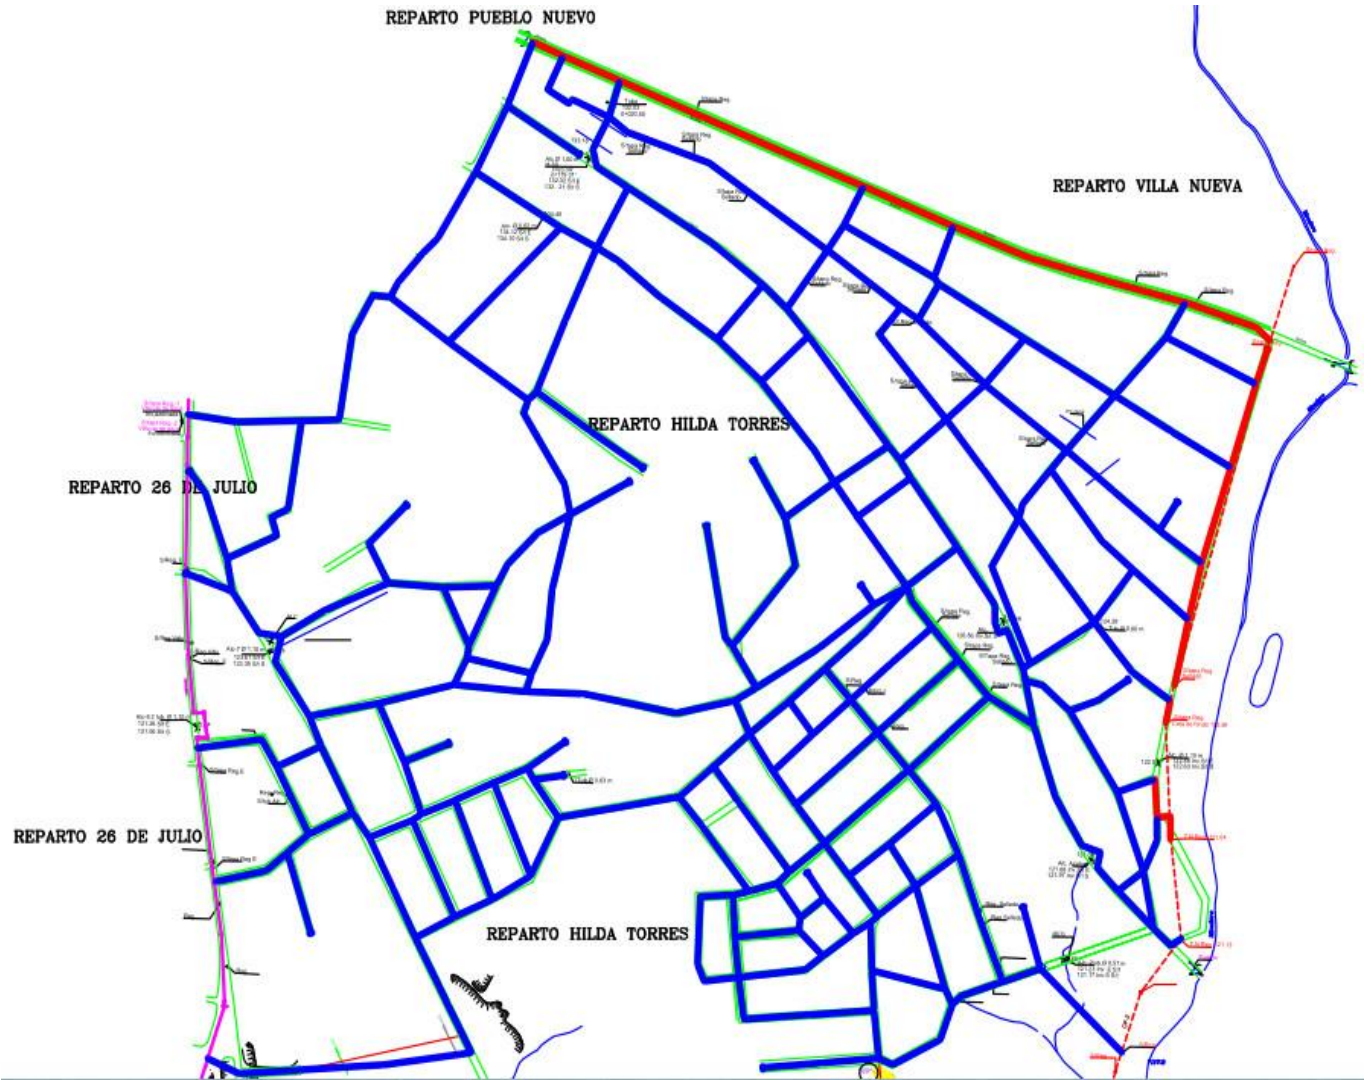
Vista en planta del modelo de la red de alcantarillado.
